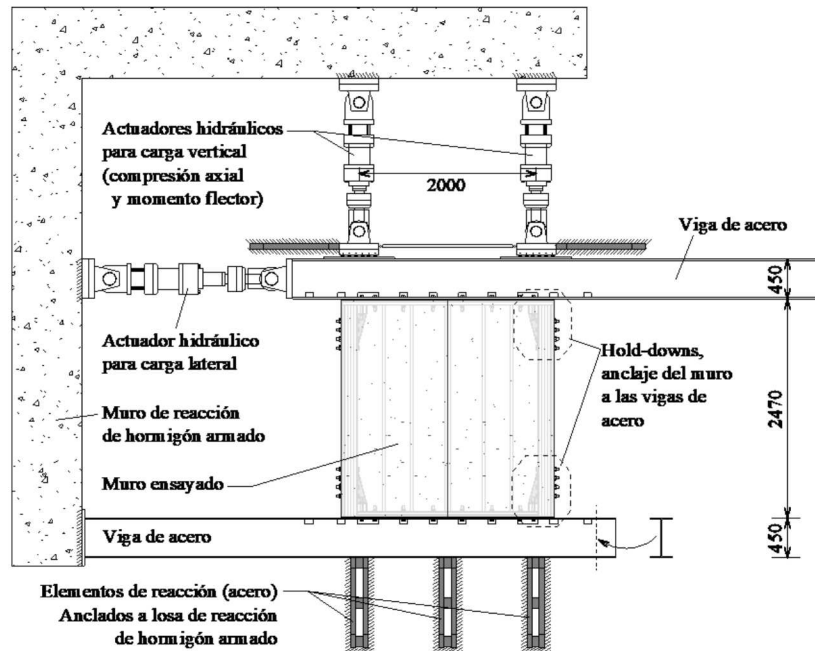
Configuración de los ensayos, vista en planta (dimensiones en mm)
